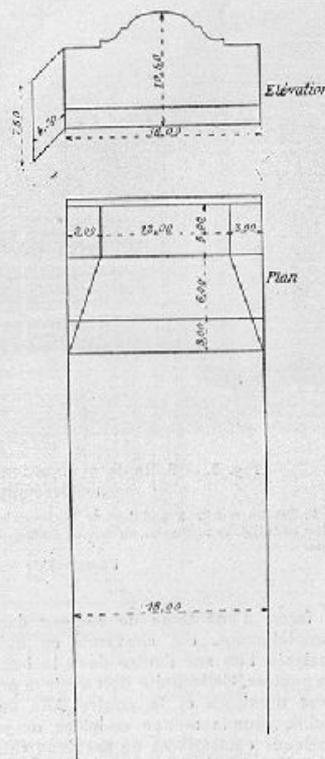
Plan et élévation d'un mur de jeu de paume.
